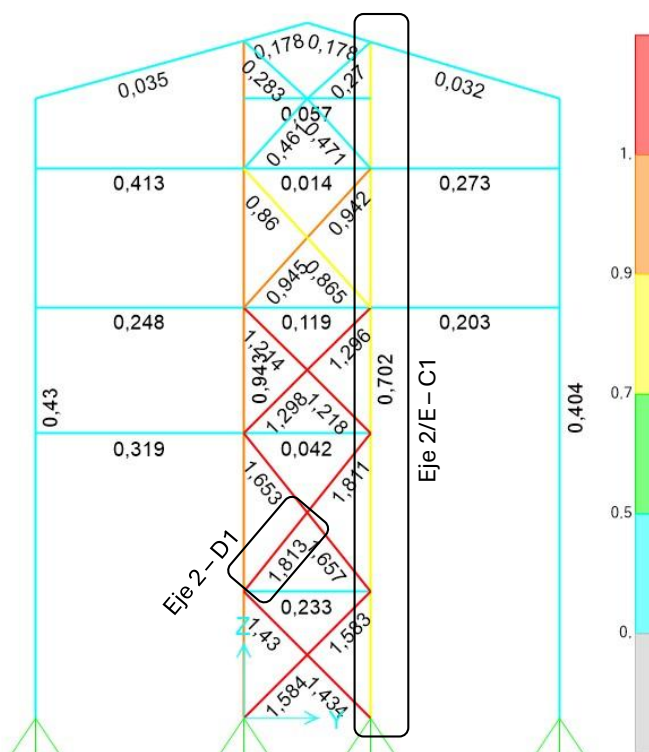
F.U. Eje 2, plano YZ, X=-2.4
